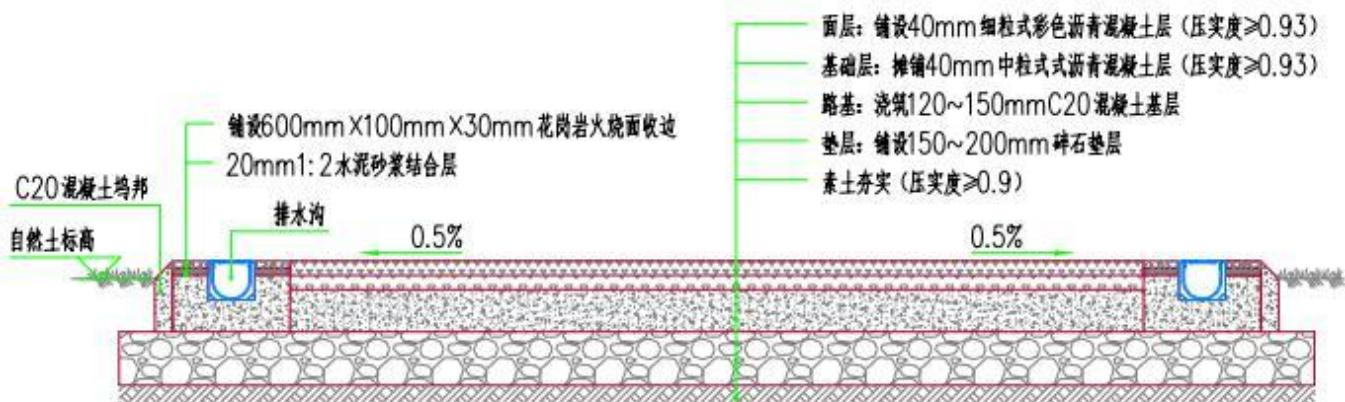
透水沥青混凝土健身步道参考平面图（双向标准段）
